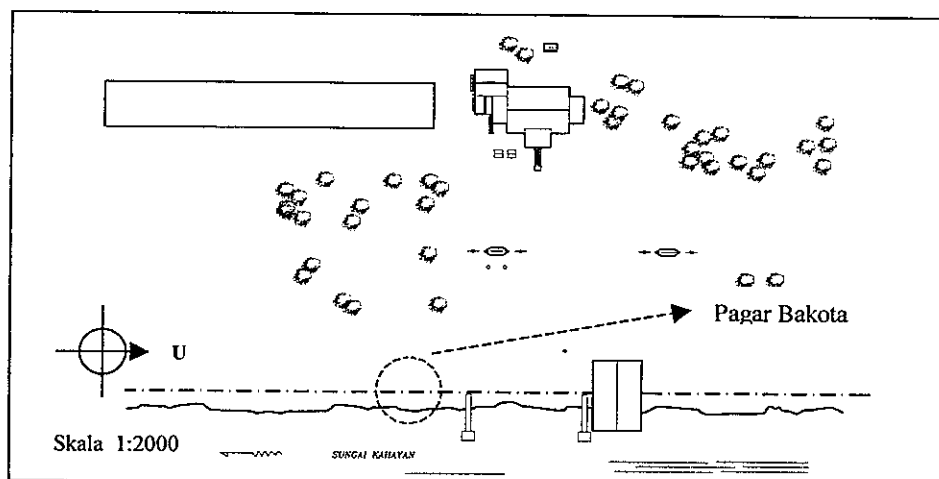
b. Bangunan Pagar Bakota di sebelah depan.
